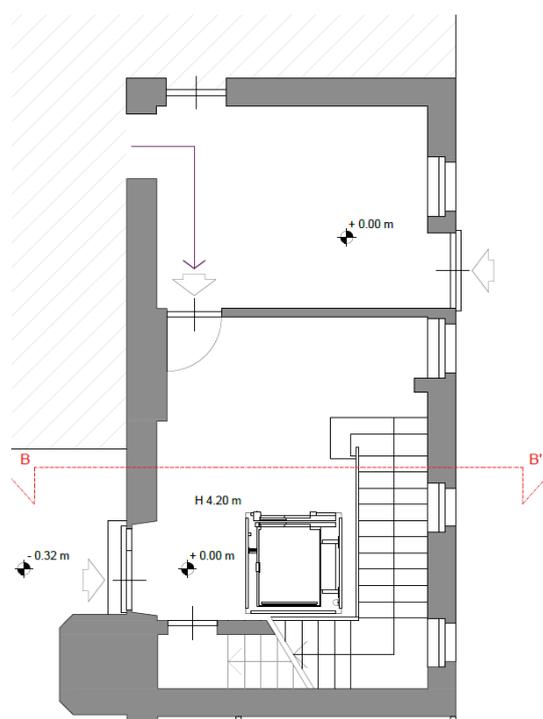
Estratto - Planimetria con indicazione del posizionamento dell'ascensore (COT1_E_ARCH_T_4001)
